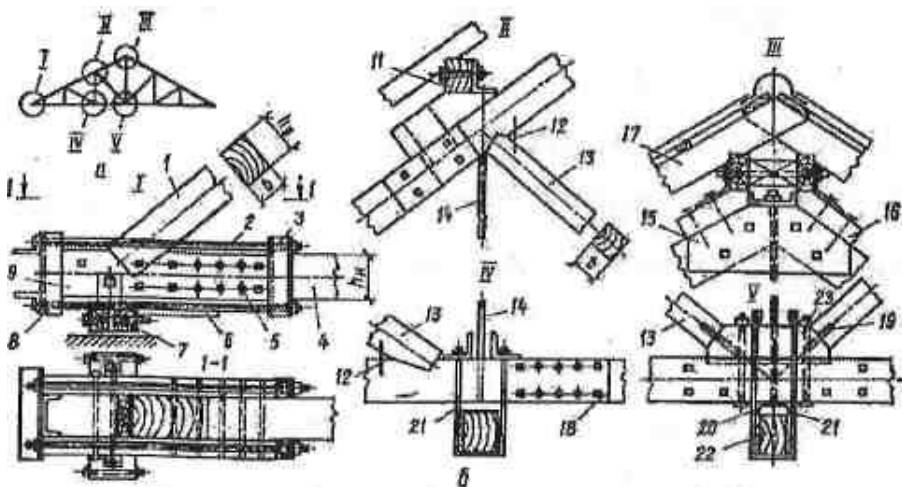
Трикутна ферма з брусів на лобових врубках із підвісним перекриттям:
